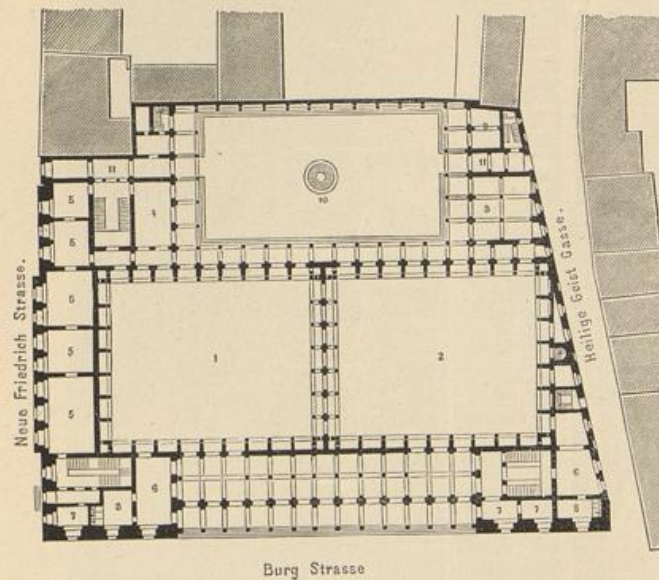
Börse. (Grundriss des Erdgeschosses.)
